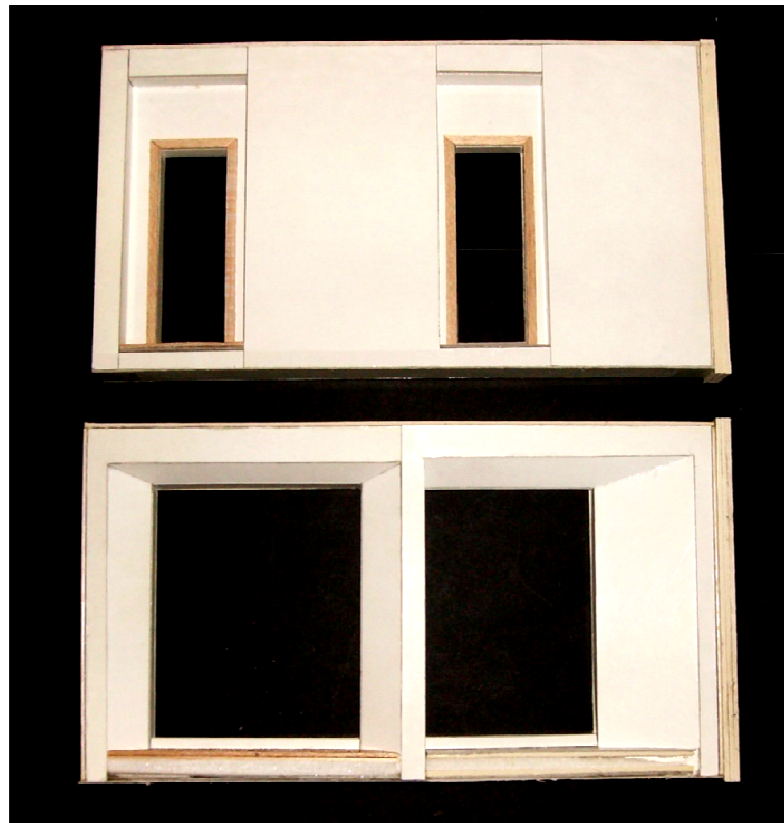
De cima para baixo: fachada tardoiz existente e fachada tardoiz proposta
